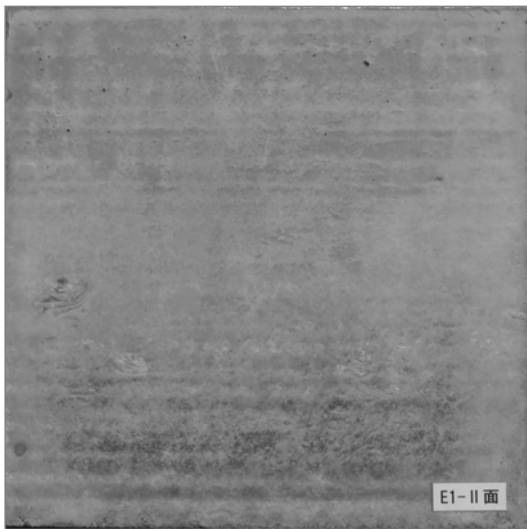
表面気泡の状況 (試験体 E, 不織布面)
